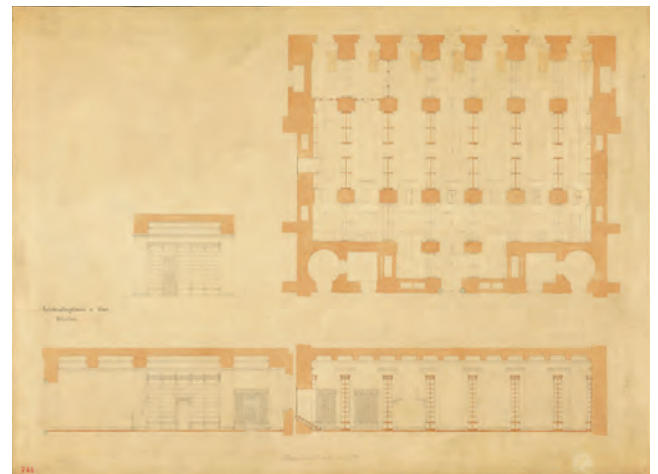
Theophil Hansen, Entwurfszeichnung, Bibliothek, Grundriss und Aufriss, Plan 748, o. D.
